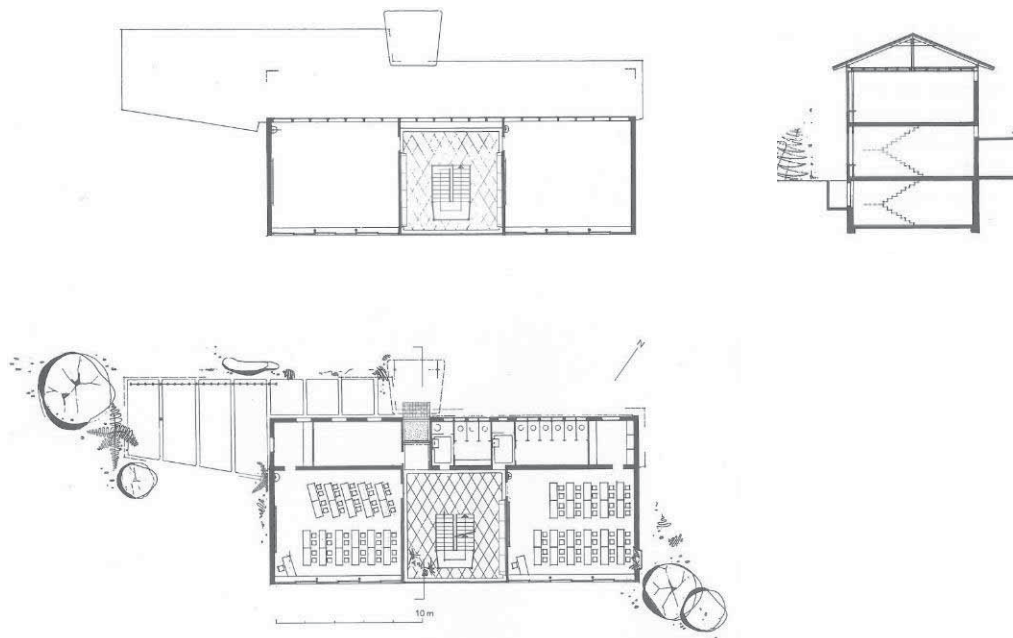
Schulanlage Steigerhubel, Bern, Treppenhallen-Typus (1. Etappe 1952-53), Grundrisse Erdgeschoss und Obergeschoss sowie Schnitt. Reinhard Architekten.
